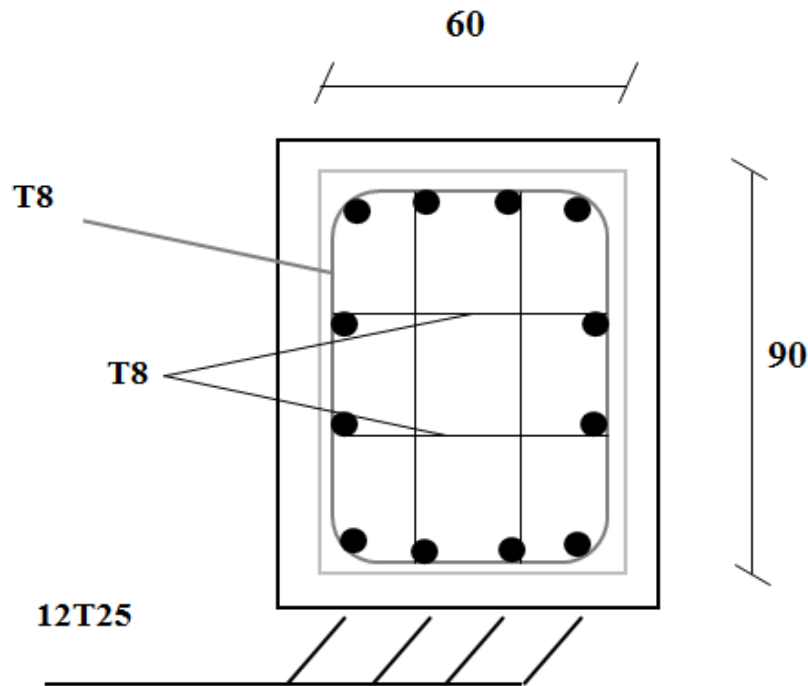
Schéma de ferrailage du poteau entre-sol.
